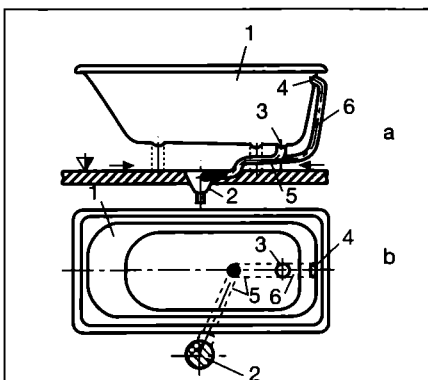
Legarea la canalizare a căzii de baie cu fund plan:
